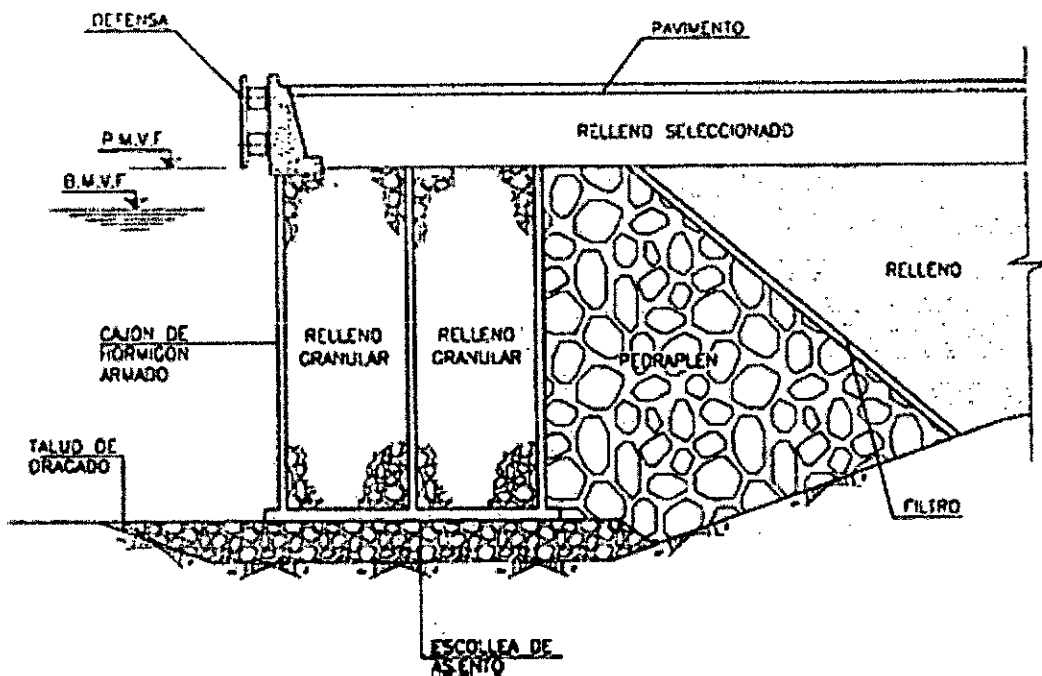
Sección tipo. Muelle de cajones de hormigón armado
